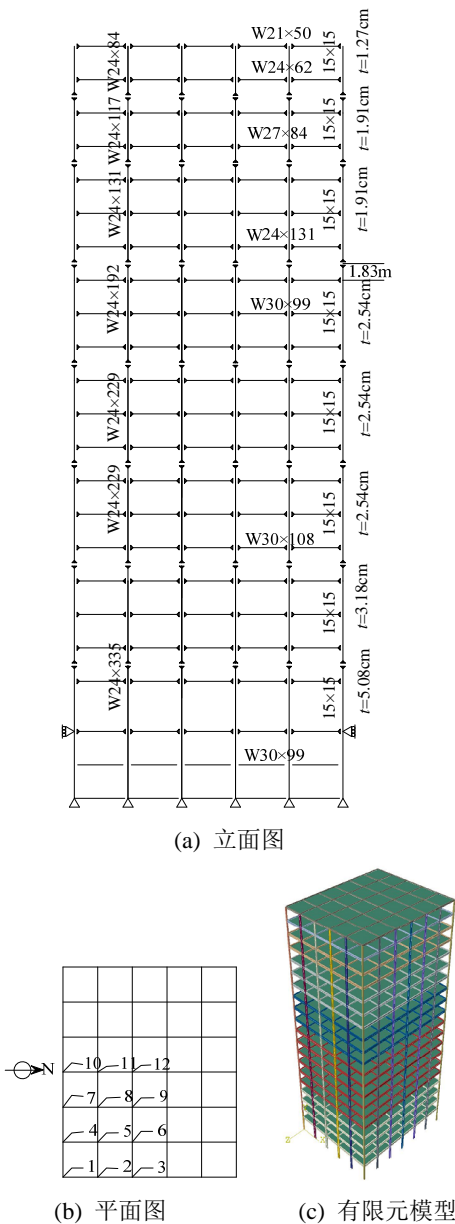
20 层 benchmark 模型立面图、平面图及有限元模型
